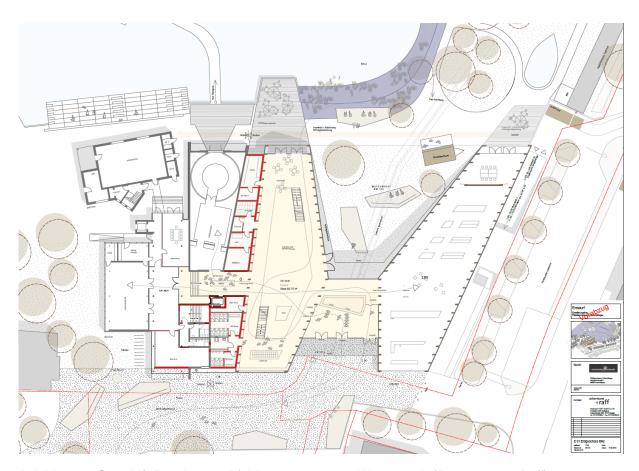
Grundriß Erweiterung Pfahlbauten aus dem Wettbewerb (Ackermann + Raff)
